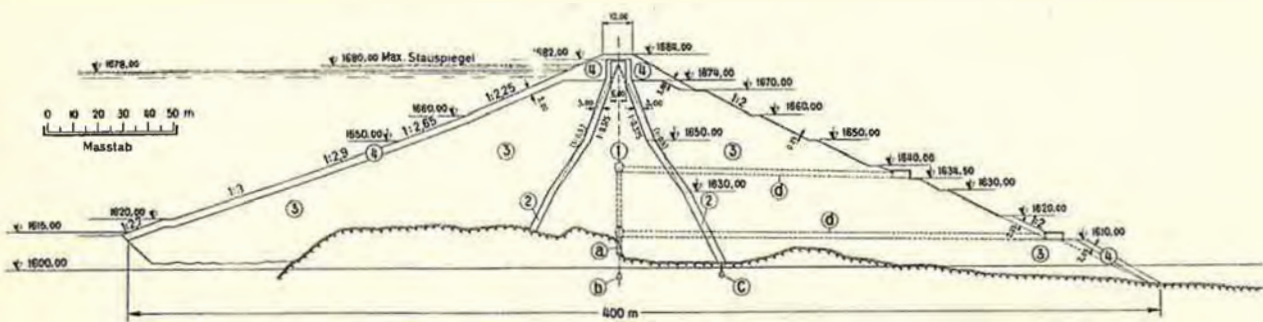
Staudamm Castiletto, Vorprojekt 1949
